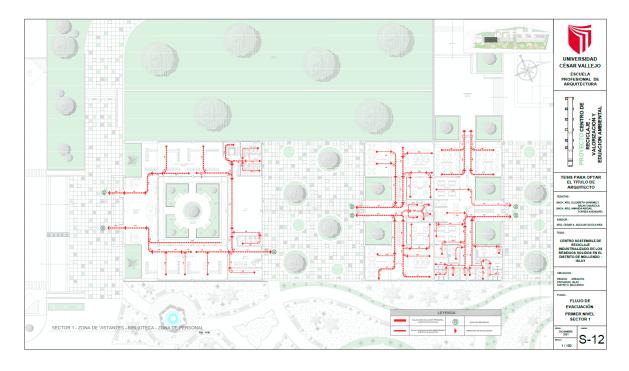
Plano de Evacuación, Sector 1 – Primer Nivel FUENTE: Elaboración Propia
